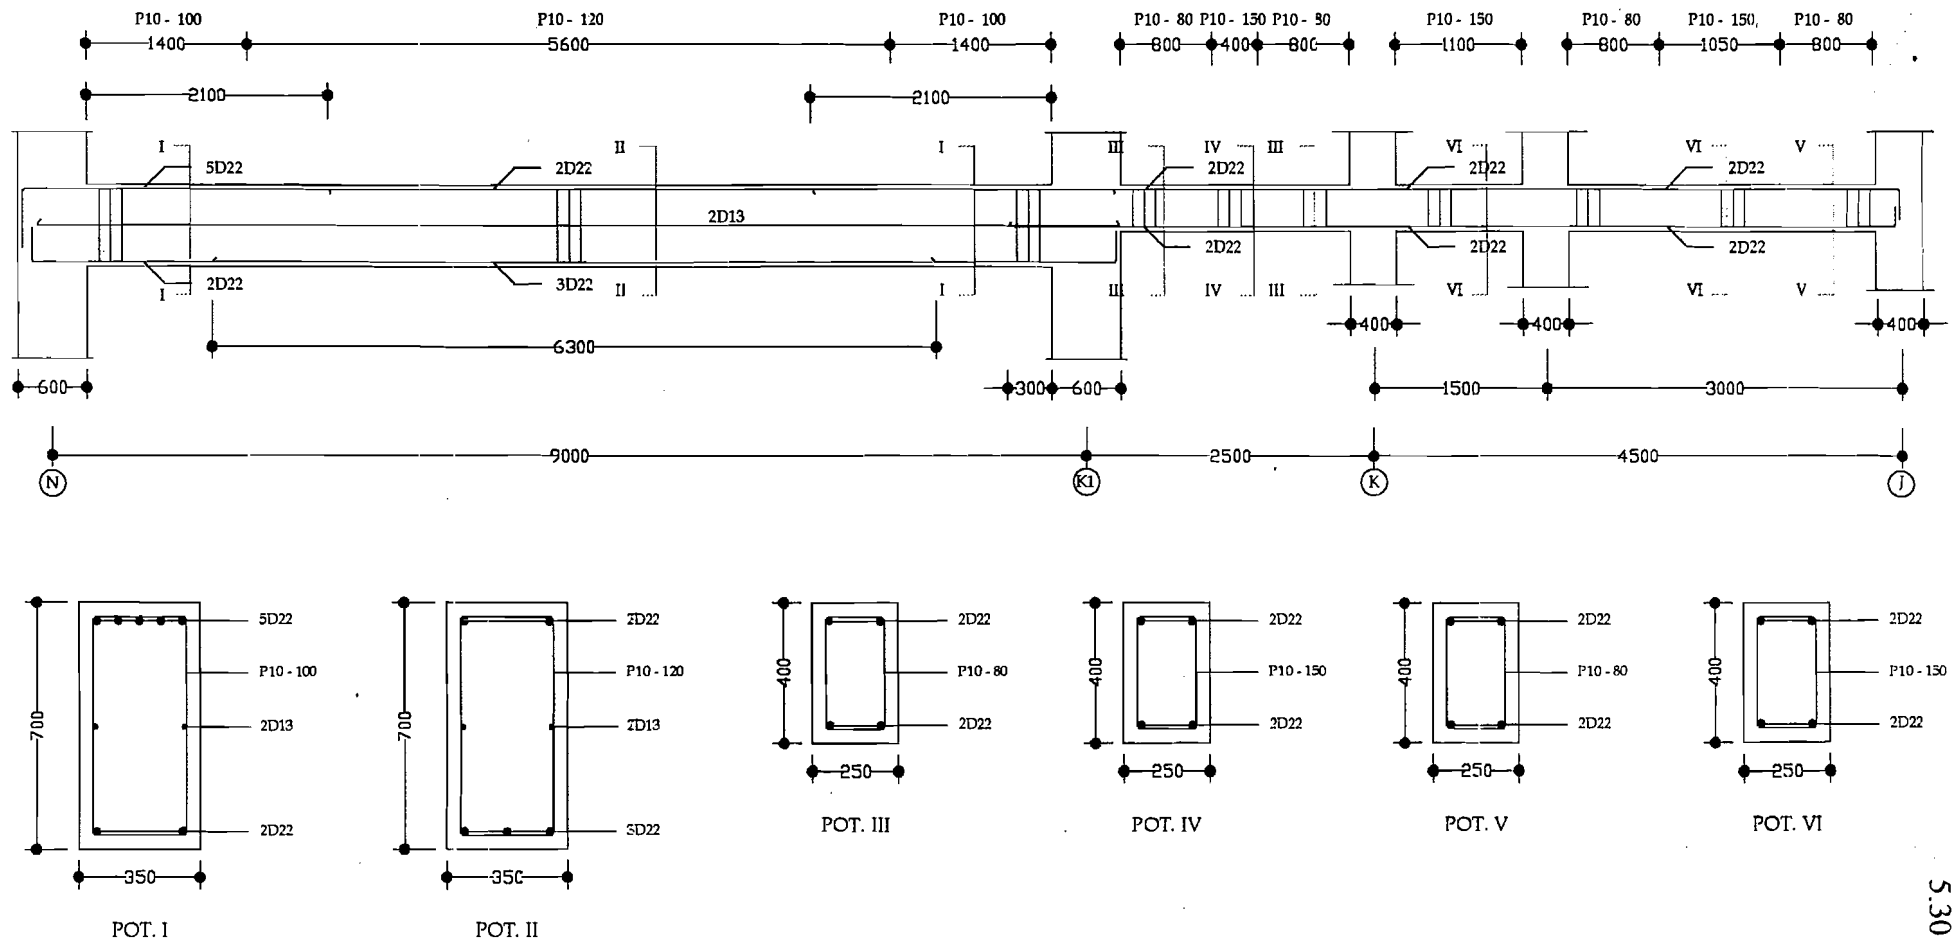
Detail Tulangan Balok Induk BA3 As K Lt 1
